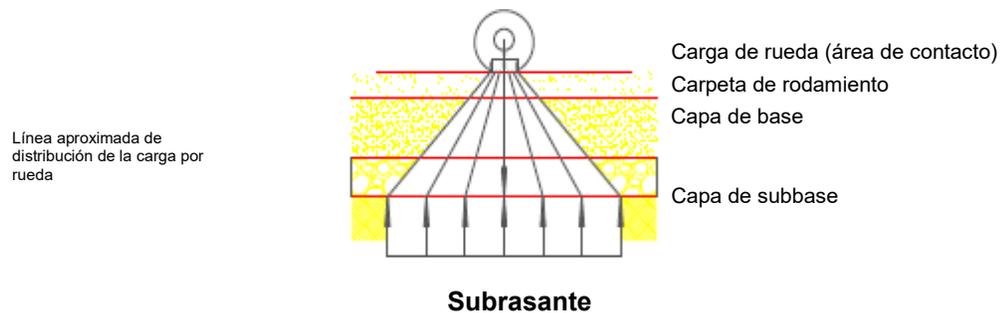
Distribución de carga de una rueda en el pavimento flexible
